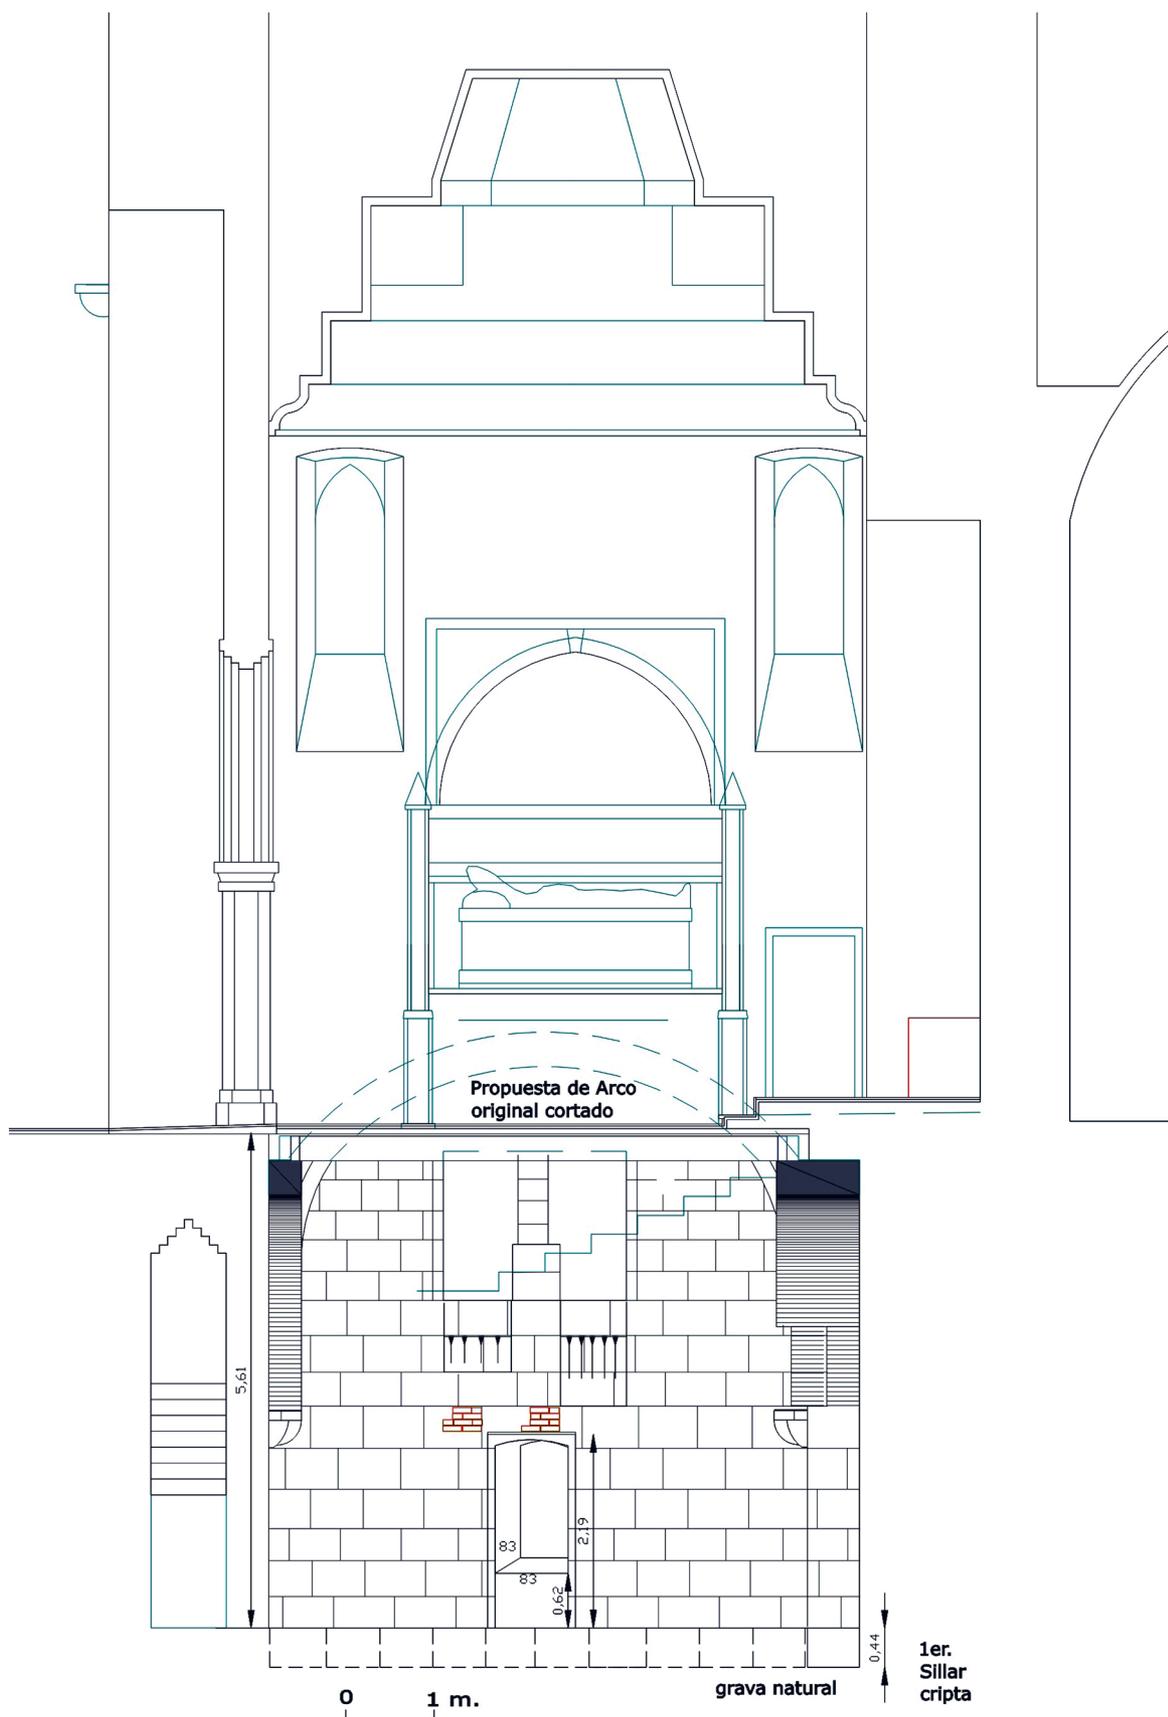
Alzado NE. Original realizado por el estudio de arquitectos PEMÁN Y FRANCO, modificado para la excavación.
